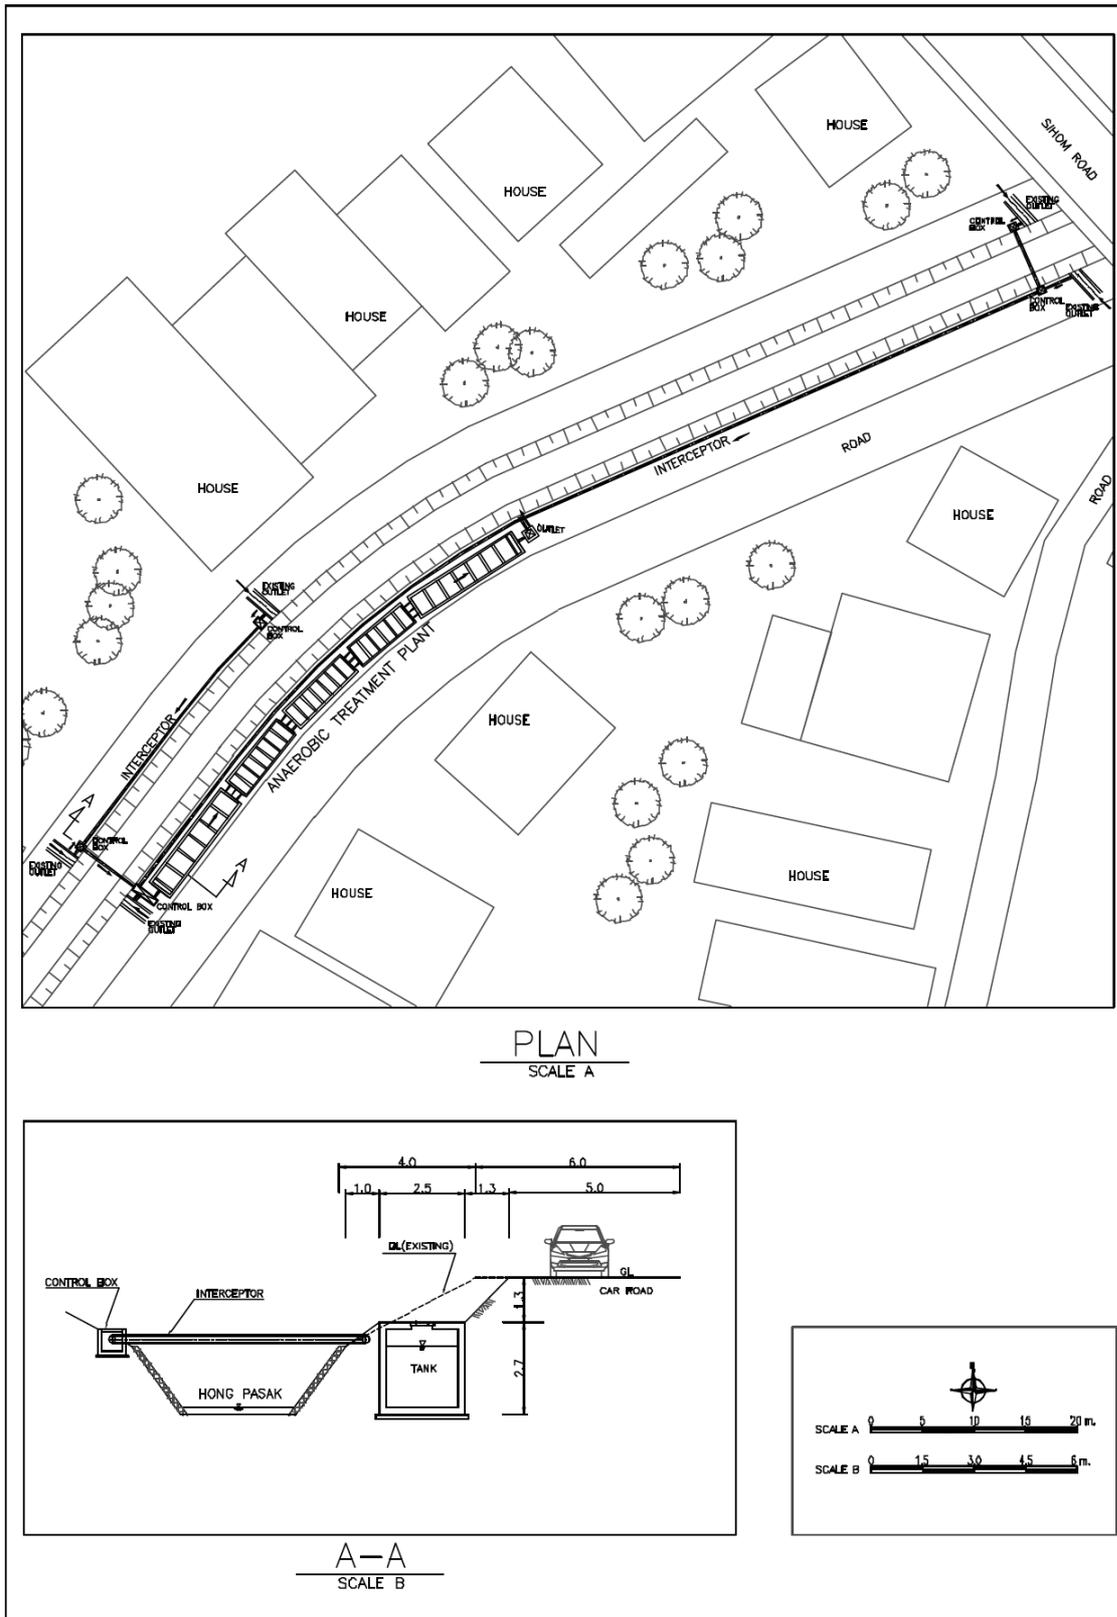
簡易処理施設 (T5) の平面図および標準断面図
